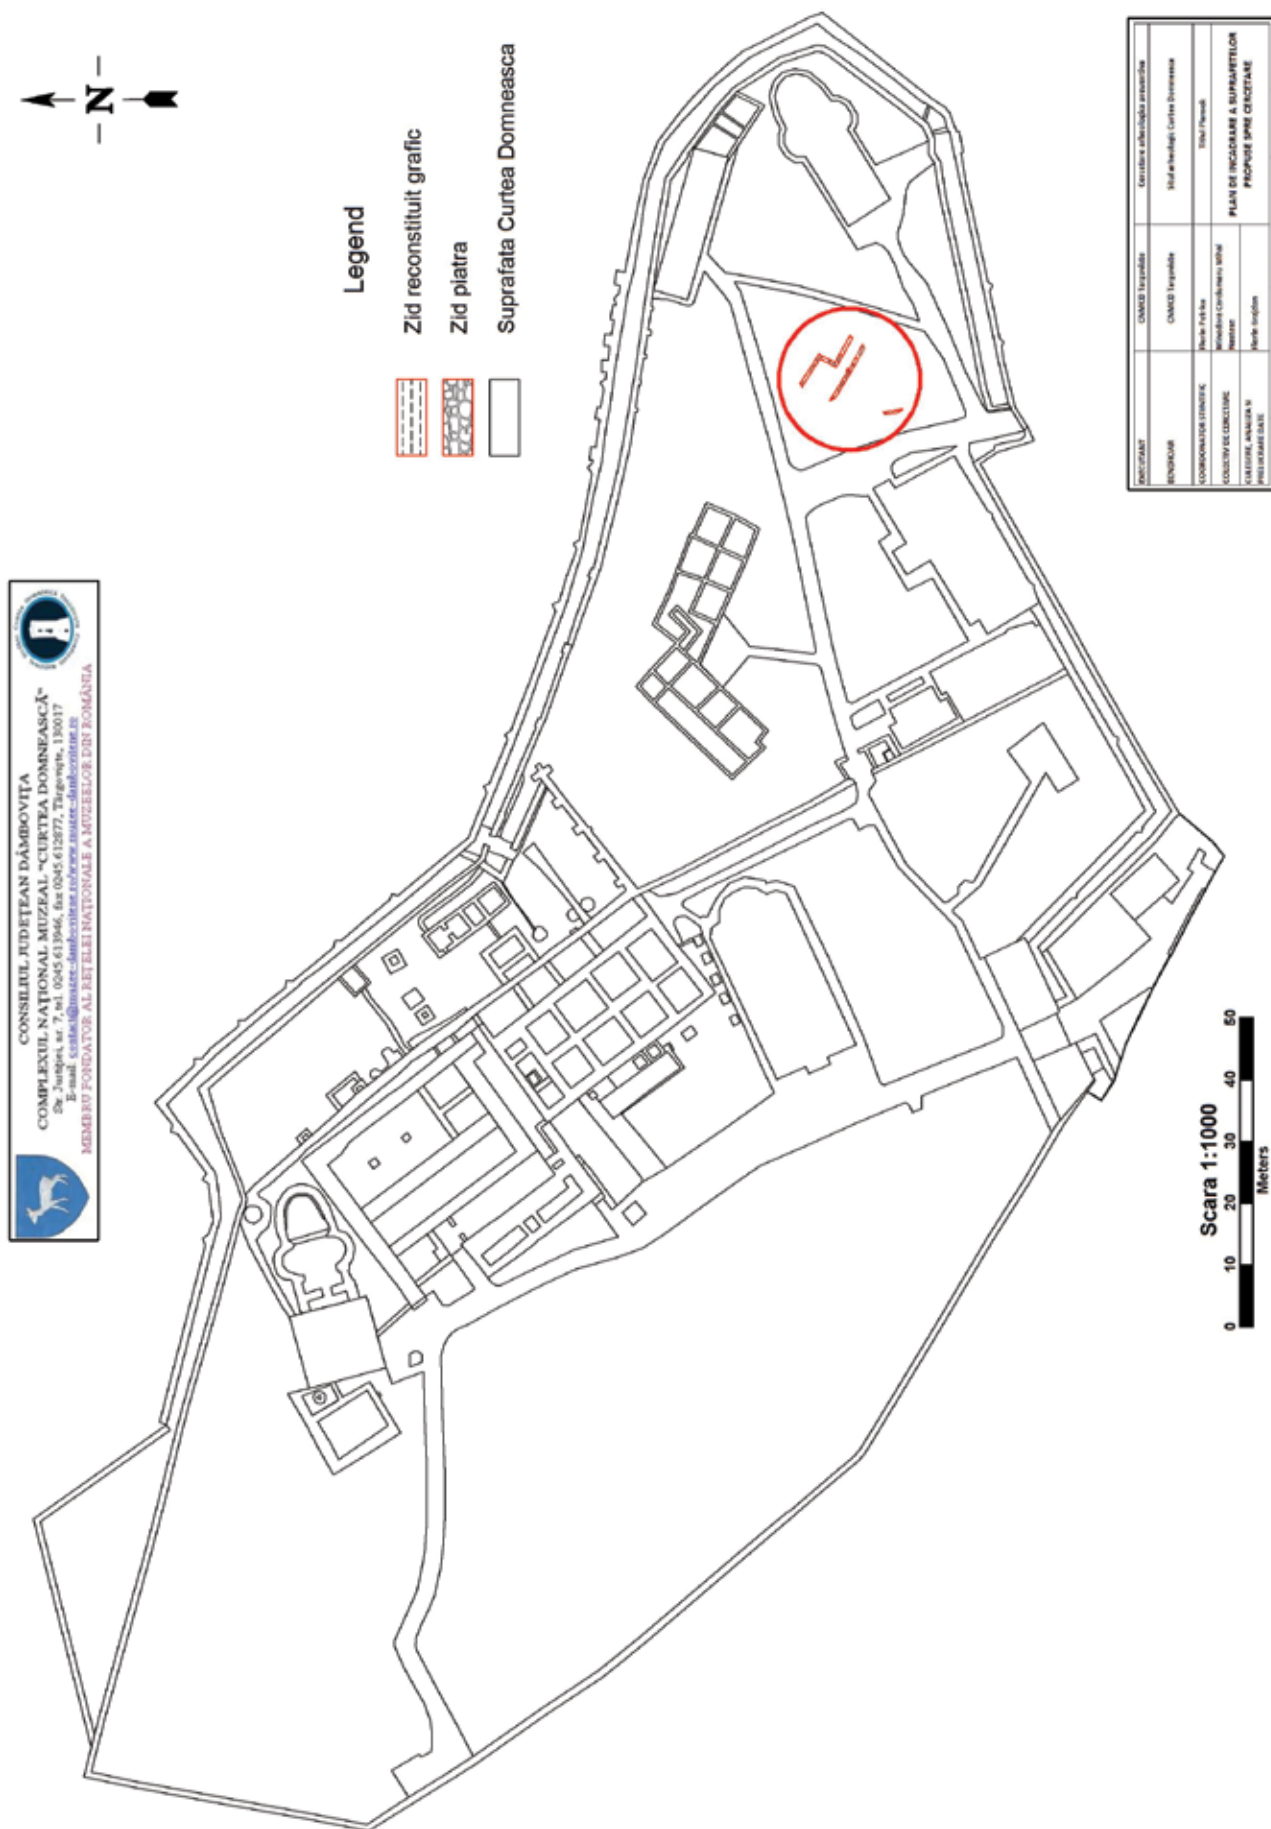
Plan A4 încadrare casă de piatră, scara 1:1000, fără grid.
